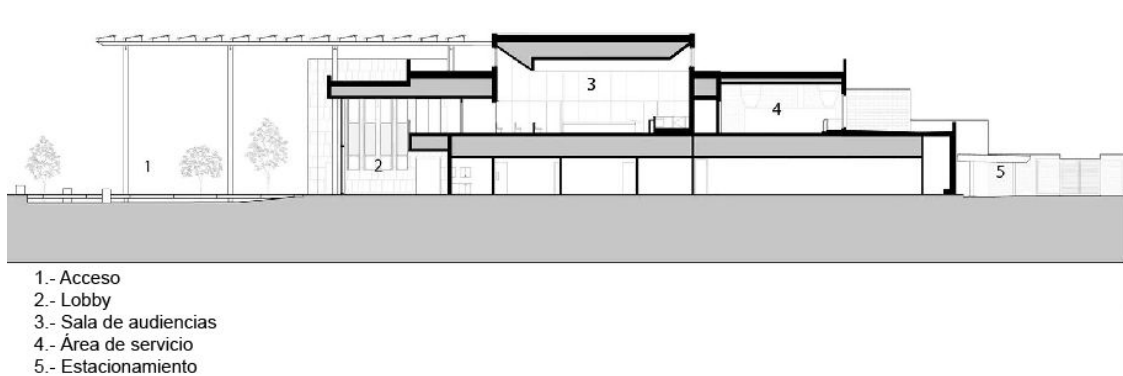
Corte arquitectónico del proyecto Palacio de Justicia John M. Roll. Fuente archdaily.mx. Sin escala.
